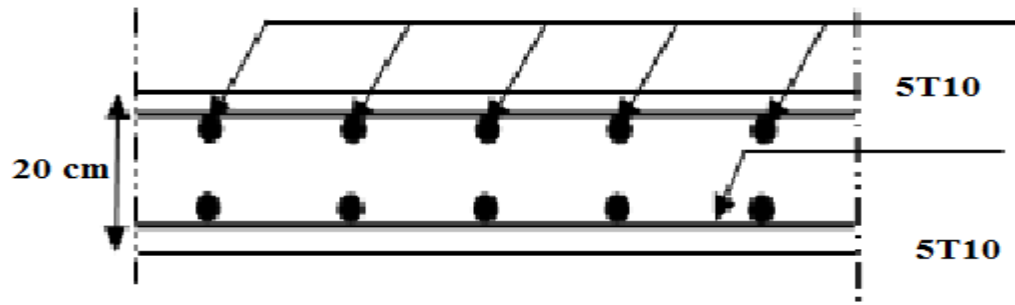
Coupe horizontale du ferrailage du voile périphérique.
